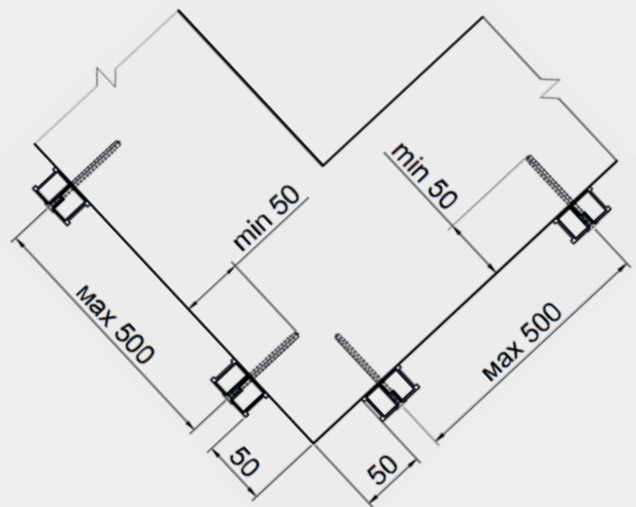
Montaje del perfil de soporte para la fijación horizontal de la fachada
